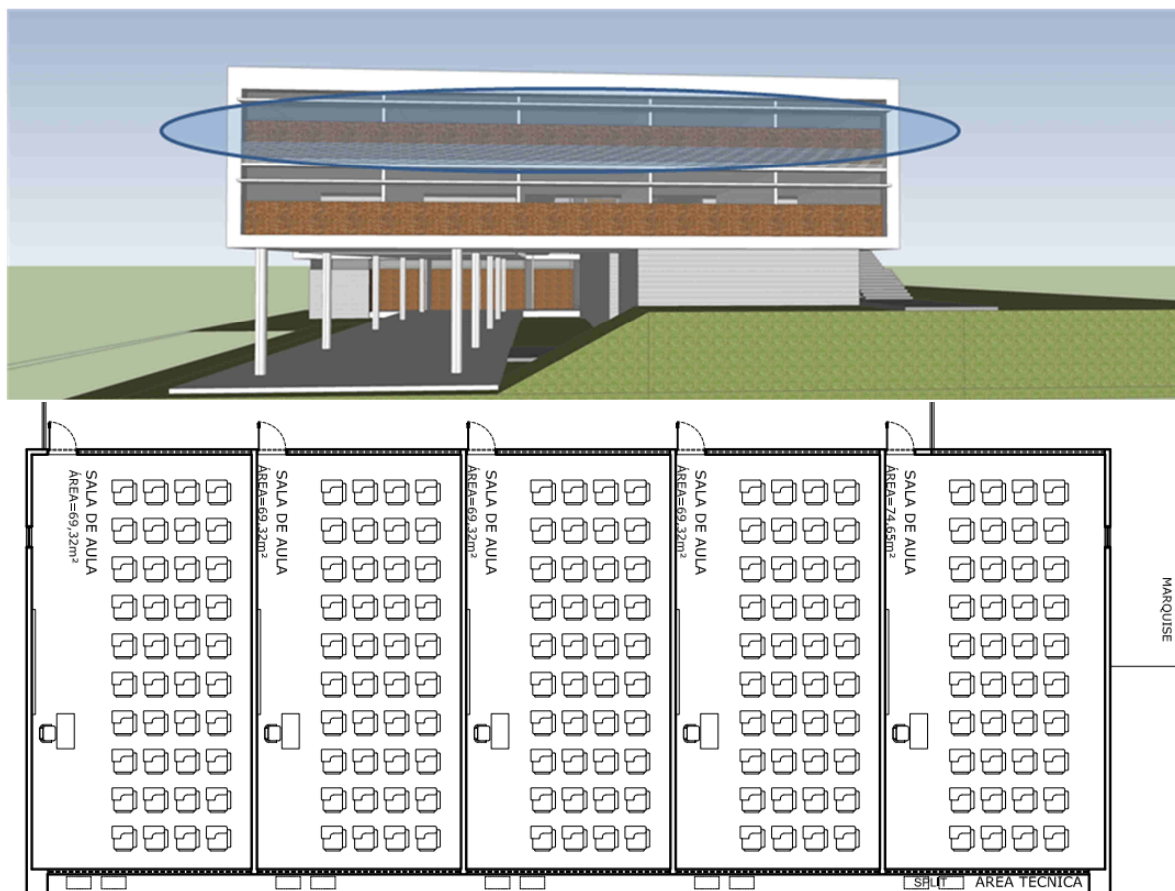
Salas de Aula - 2º Pavimento Bloco 01 - Fachada e Planta Baixa
